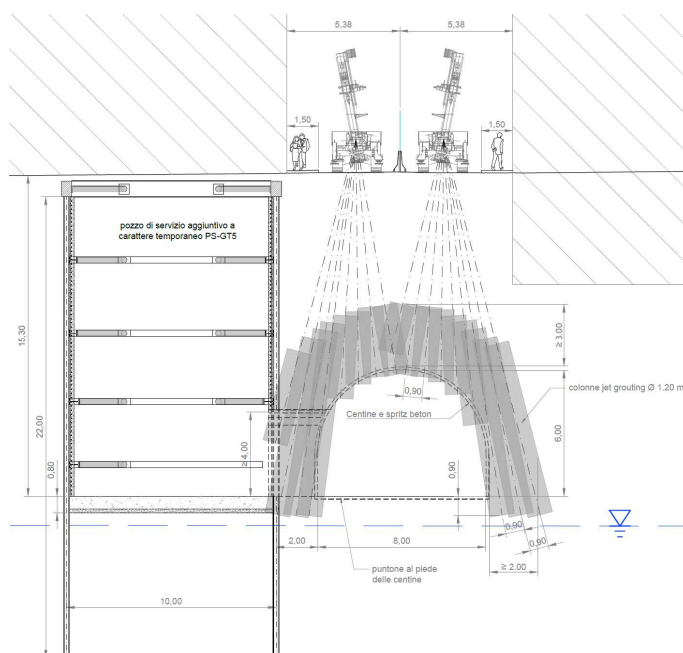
Trattamento jet grouting per il cunicolo PS-GT5: sezione corrente
